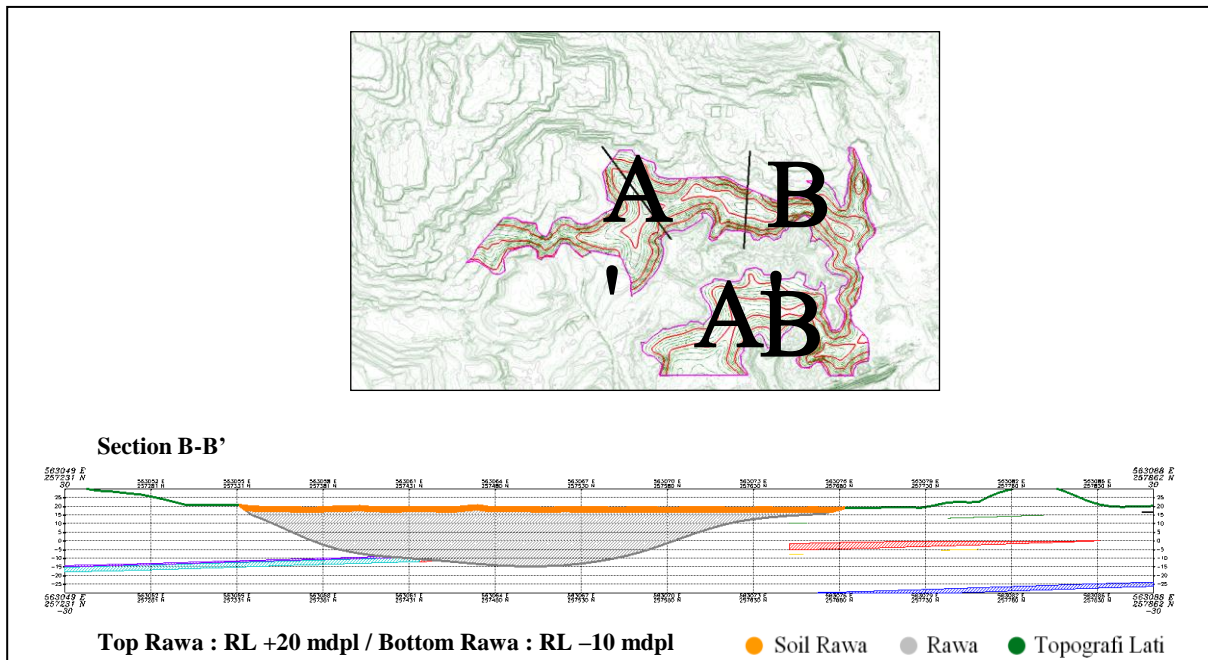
Area rawa yang masuk dalam rencana bukaan lahan Pit West
